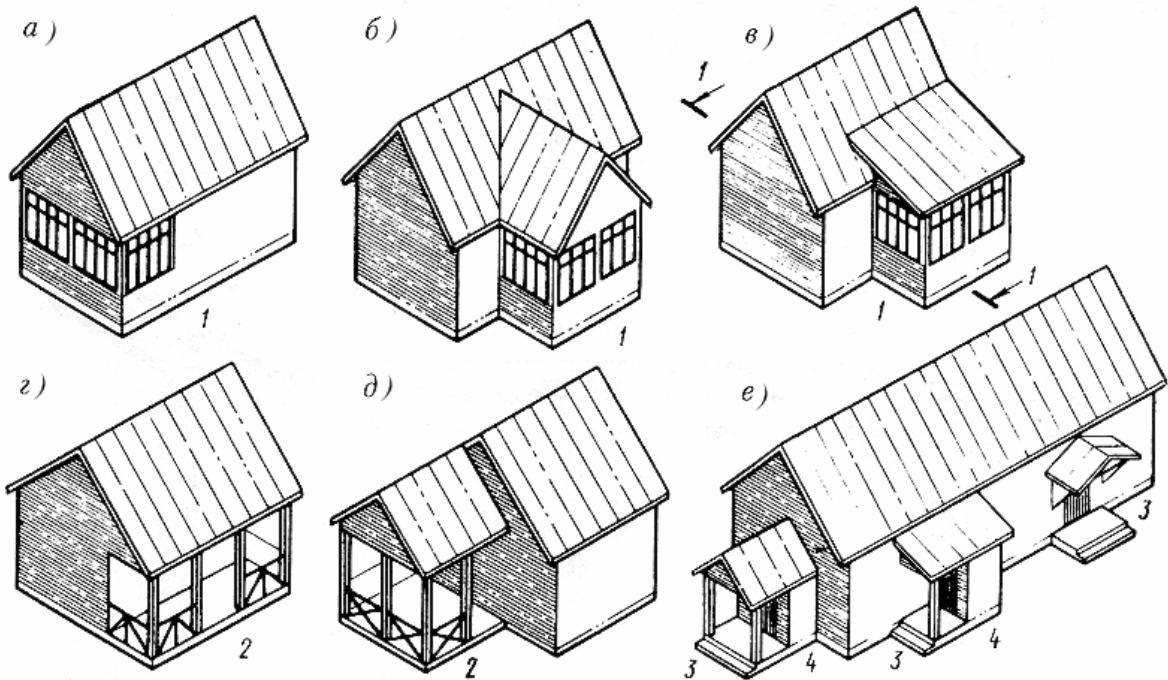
Летние приквартирные помещения малоэтажных жилых зданий:
